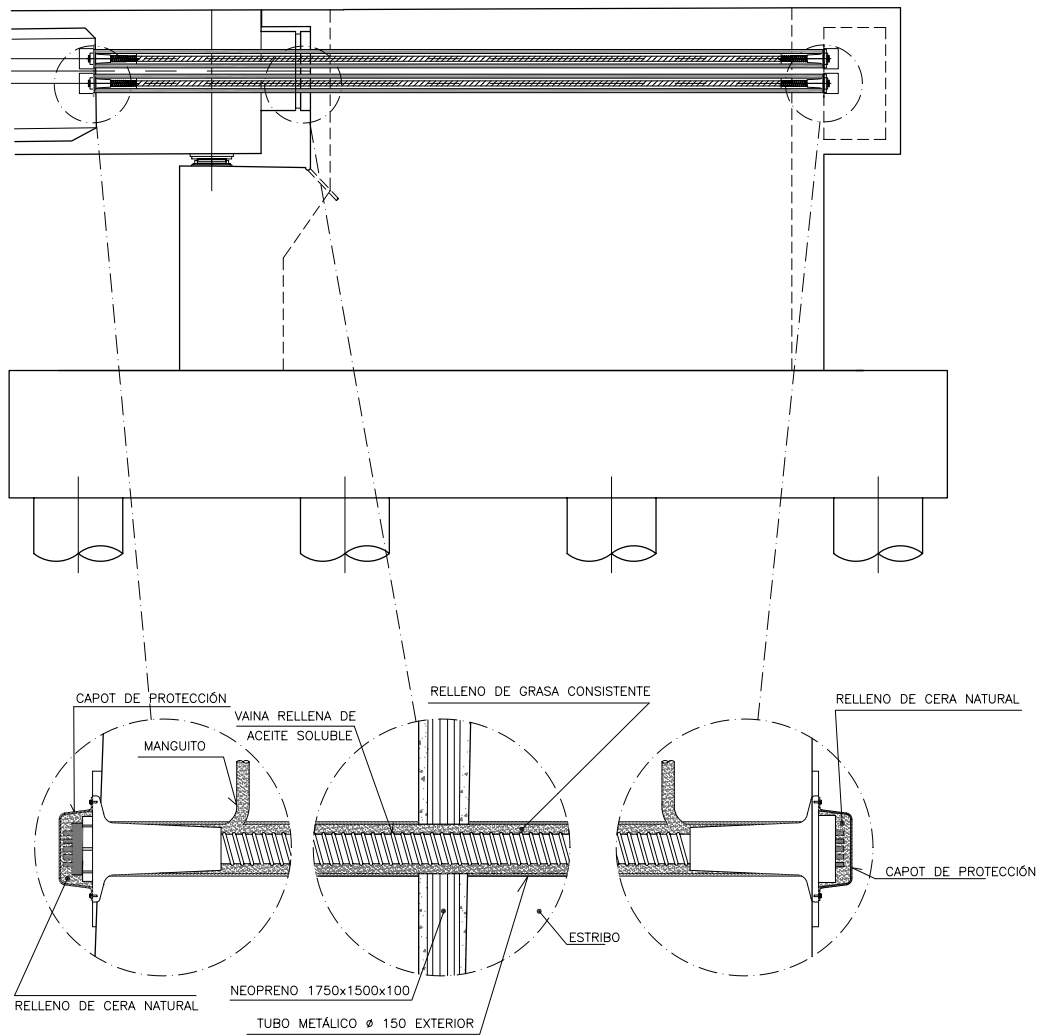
Estribo fijo de tablero tipo cajón de hormigón pretensado. Sección longitudinal
